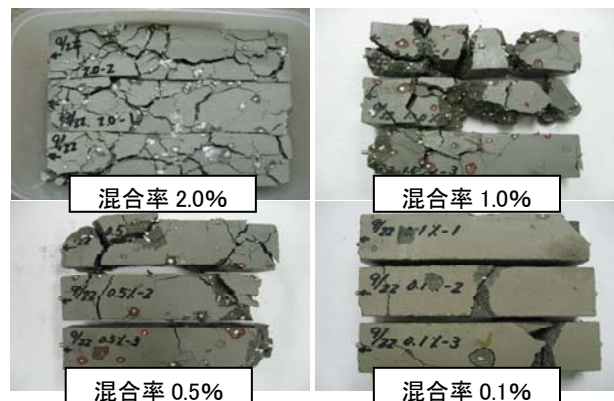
ポップアウトの発生状況 (粒径 2.5~1.2mm)
